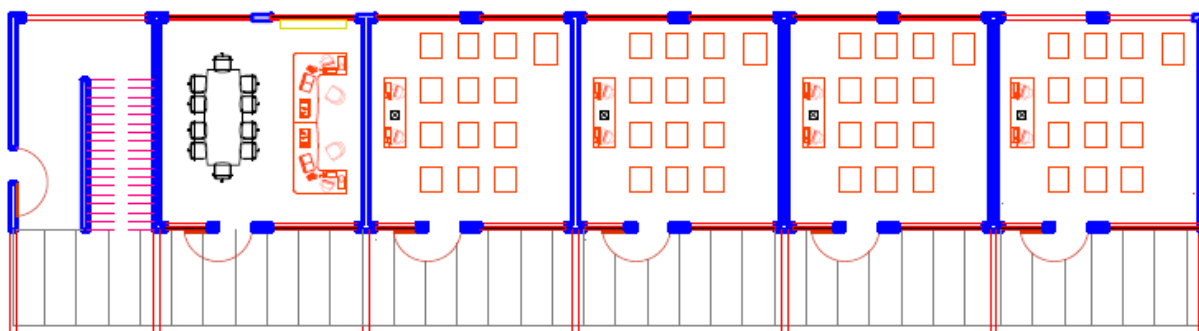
Planta tipo del edificio. Fuente: AutoCAD (elaboración propia).
